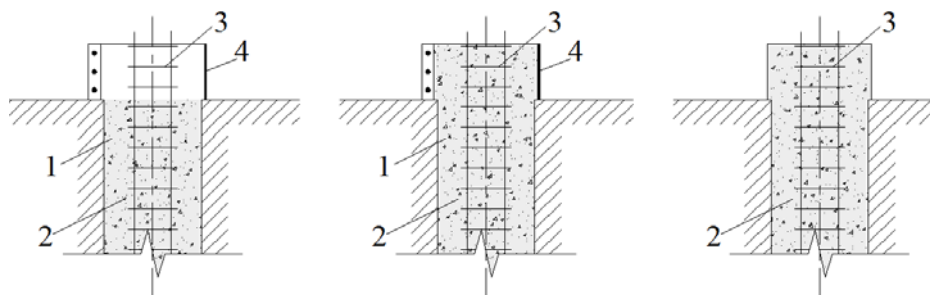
Технологическая схема устройства оголовка НРСн в инвентарной опалубке: 1- раскатанная скважина; 2- свежеложенная бетонная смесь; 3- арматурный каркас; 4- опалубка.
